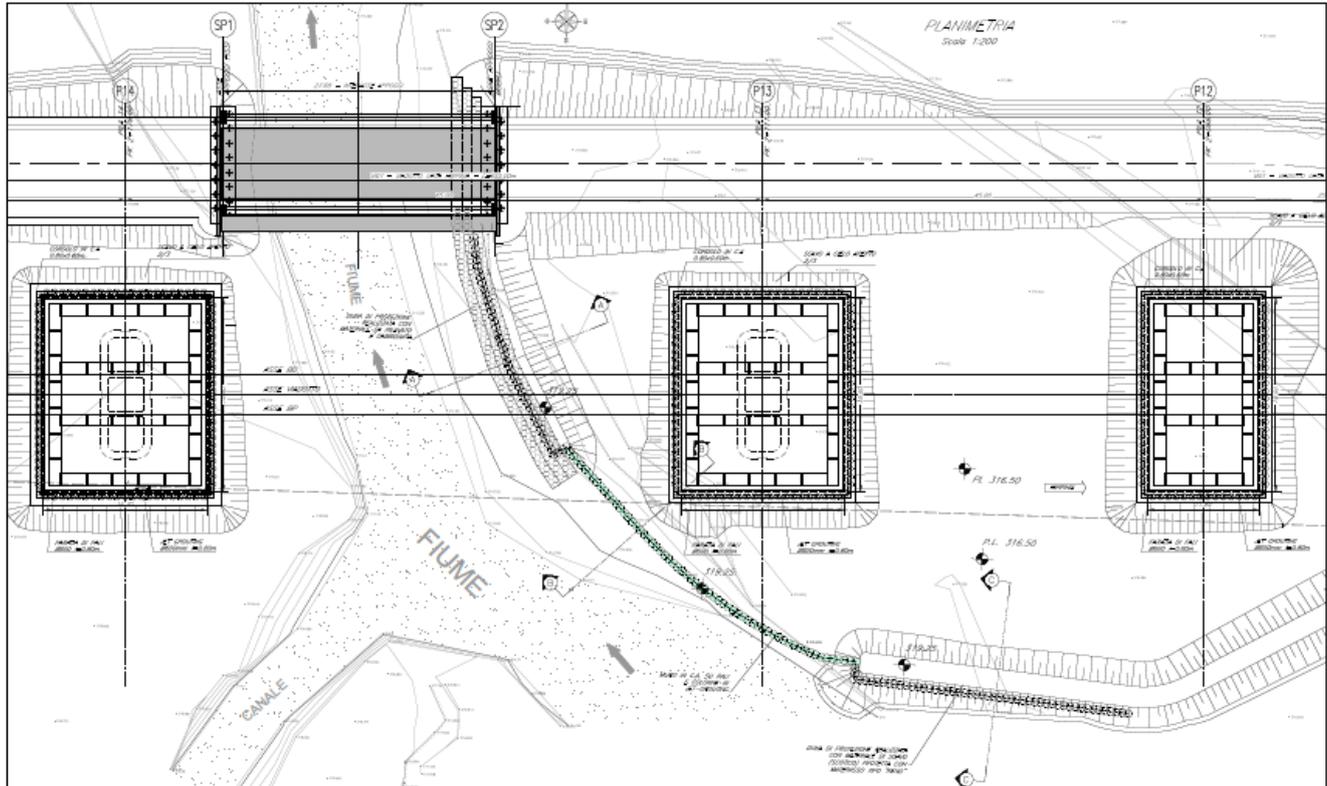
Attraversamento pista di cantiere VI01 mediante ponte tipo Bailey o similare
